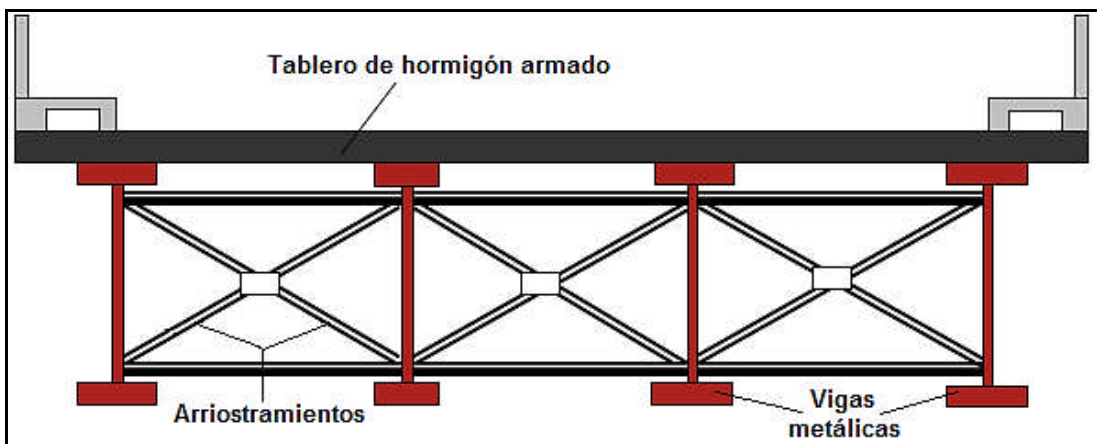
Sección Transversal de la vereda. Puente Oyacachi
